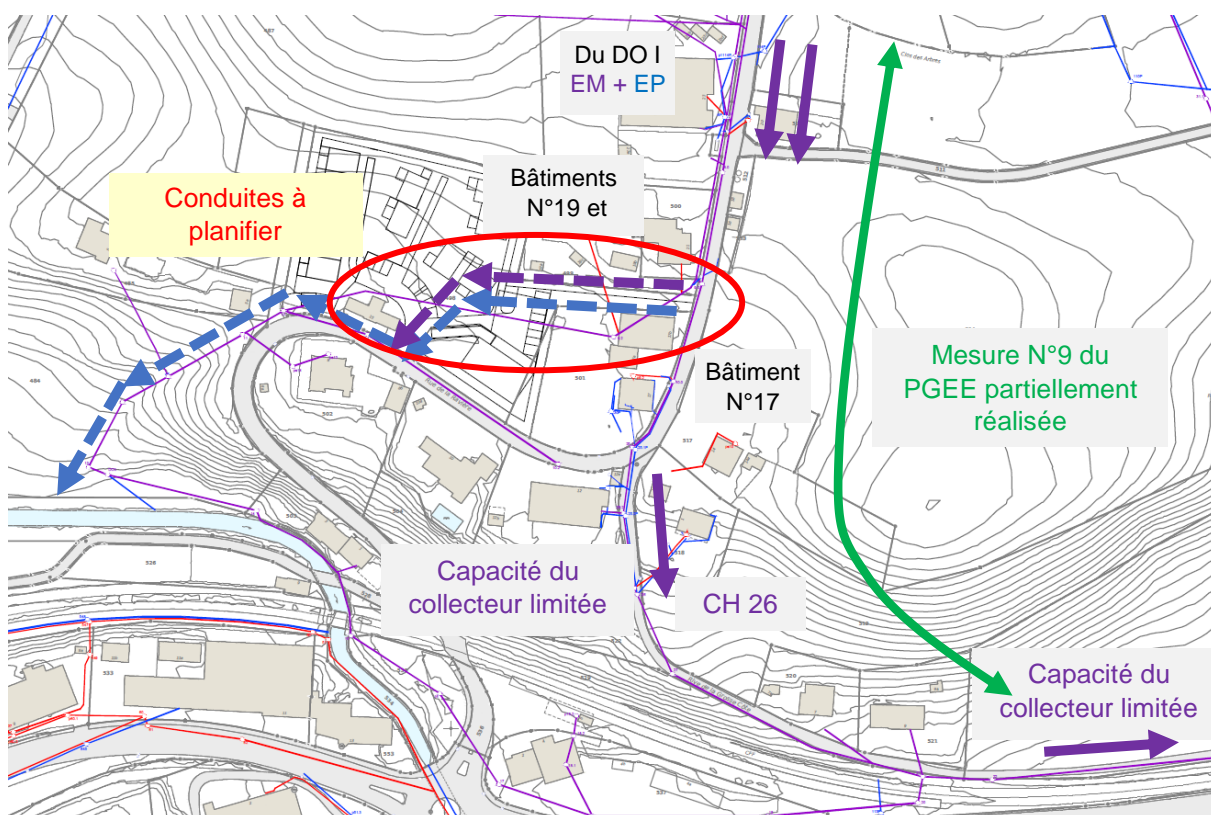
SITUATION ACTUELLE ET PROPOSITION DE CONDUITES À PLANIFIER
